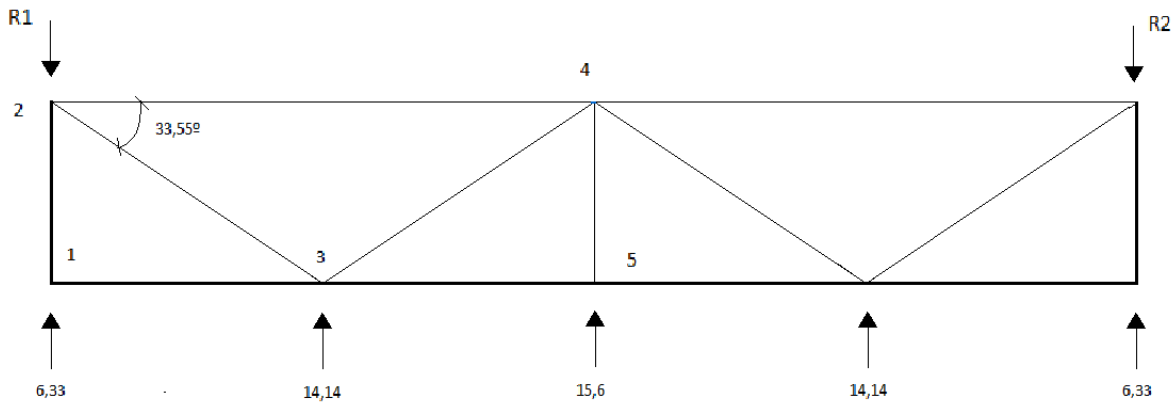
Configuración de los nudos de la viga contraviento.
